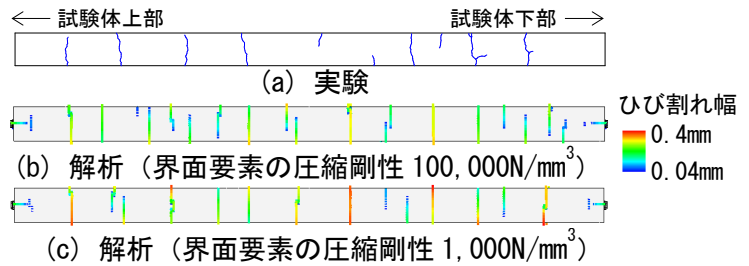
鉄筋引張応力度 180N/mm^2 時点のひび割れ図
